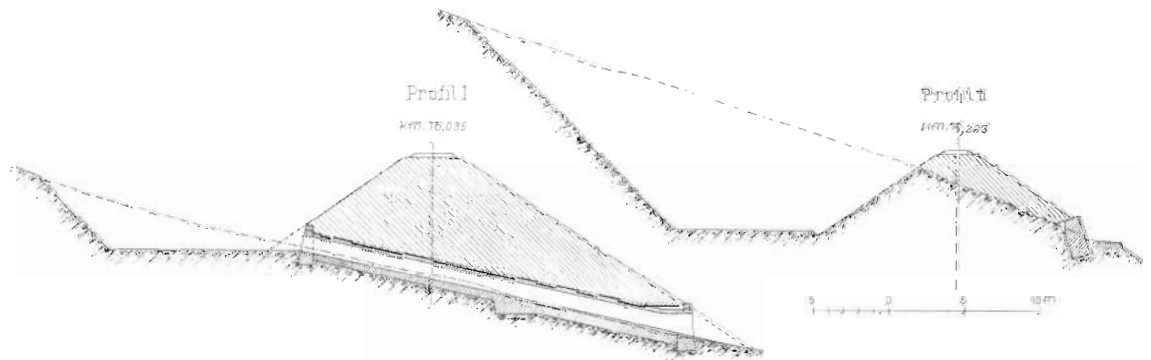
und 21. Lawinen-Fallböden im Breittrifzug. — Lageplan 1 : 4000, Querprofile 1 : 500.
